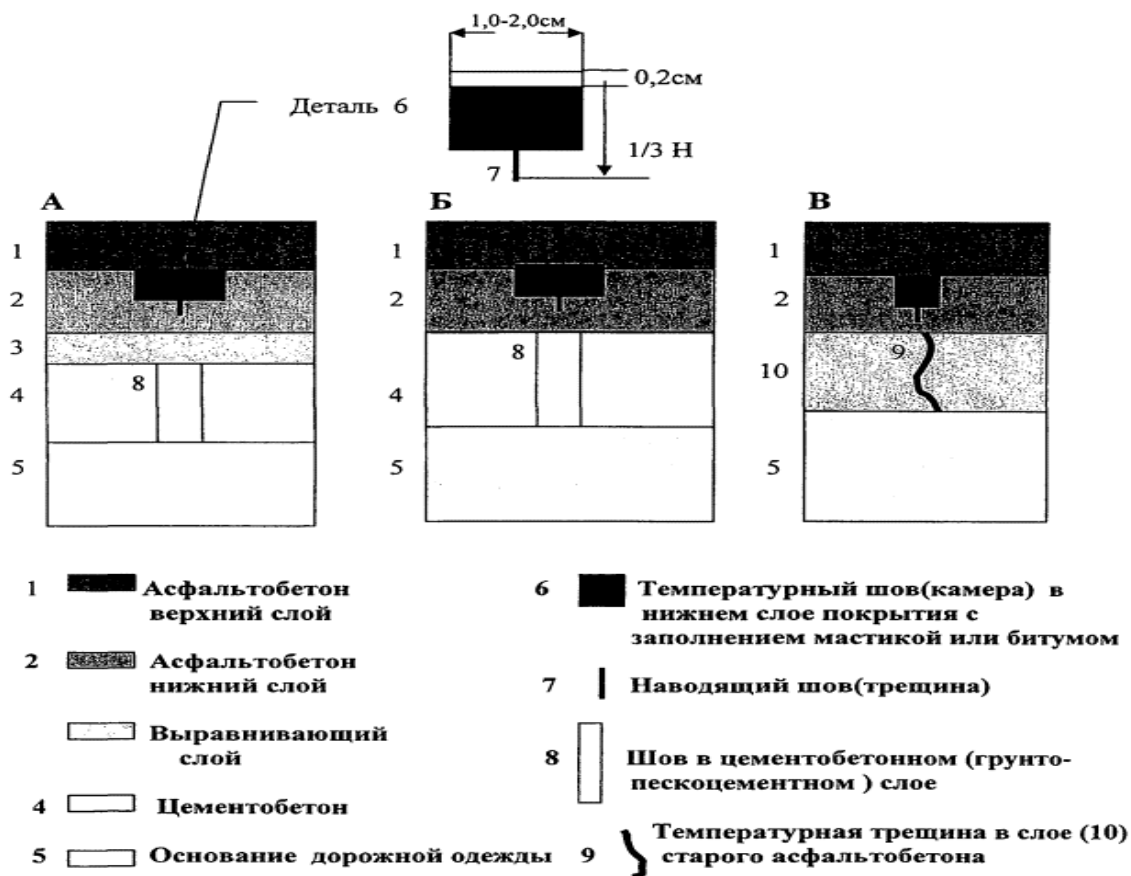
Схема нарезки температурного шва в нижнем слое асфальтобетонного покрытия
